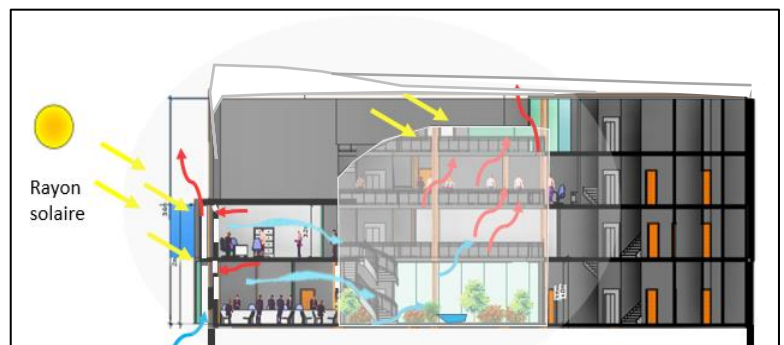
coupe schématique ventilation par le couplage de deux phénomènes façade ventilée et atrium
